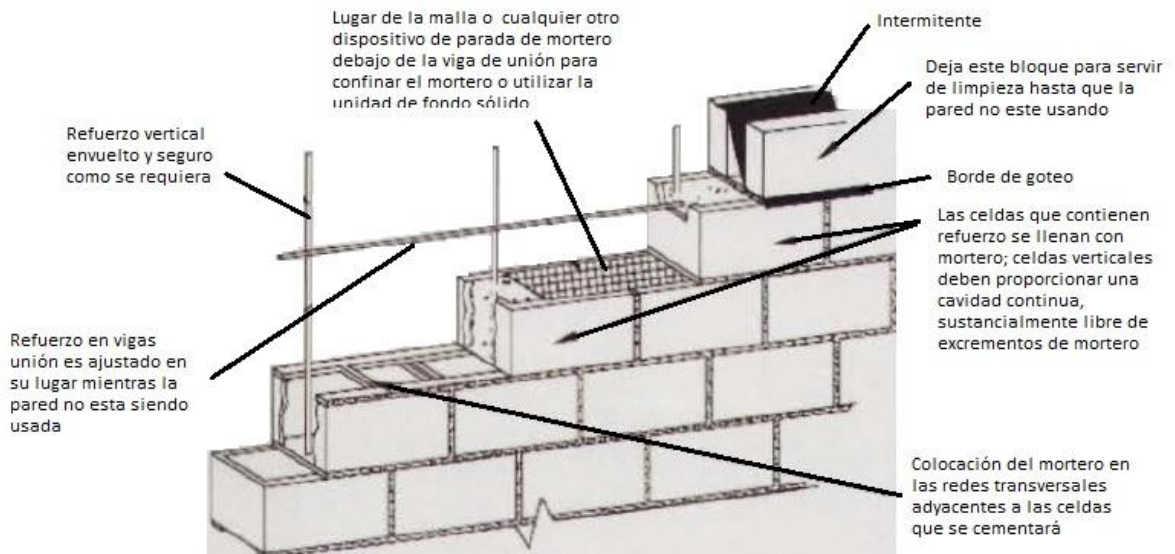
Refuerzo típico de una sección de pared de mampostería reforzada
